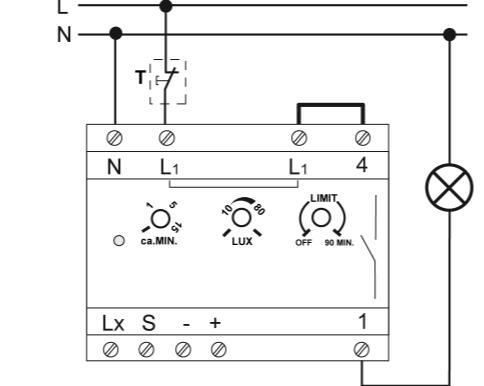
Anschlussplan Leistungsteil 1-Kanal
